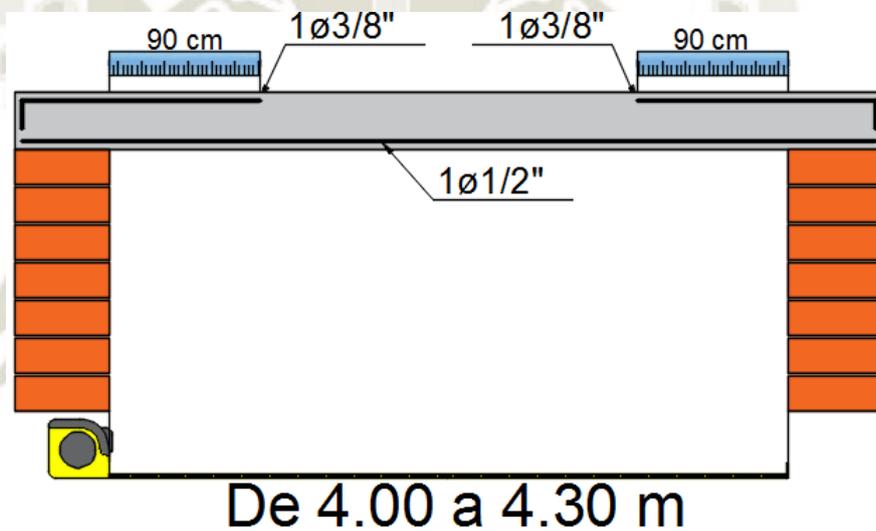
Refuerzo de vigueta hasta 4.30 m.
